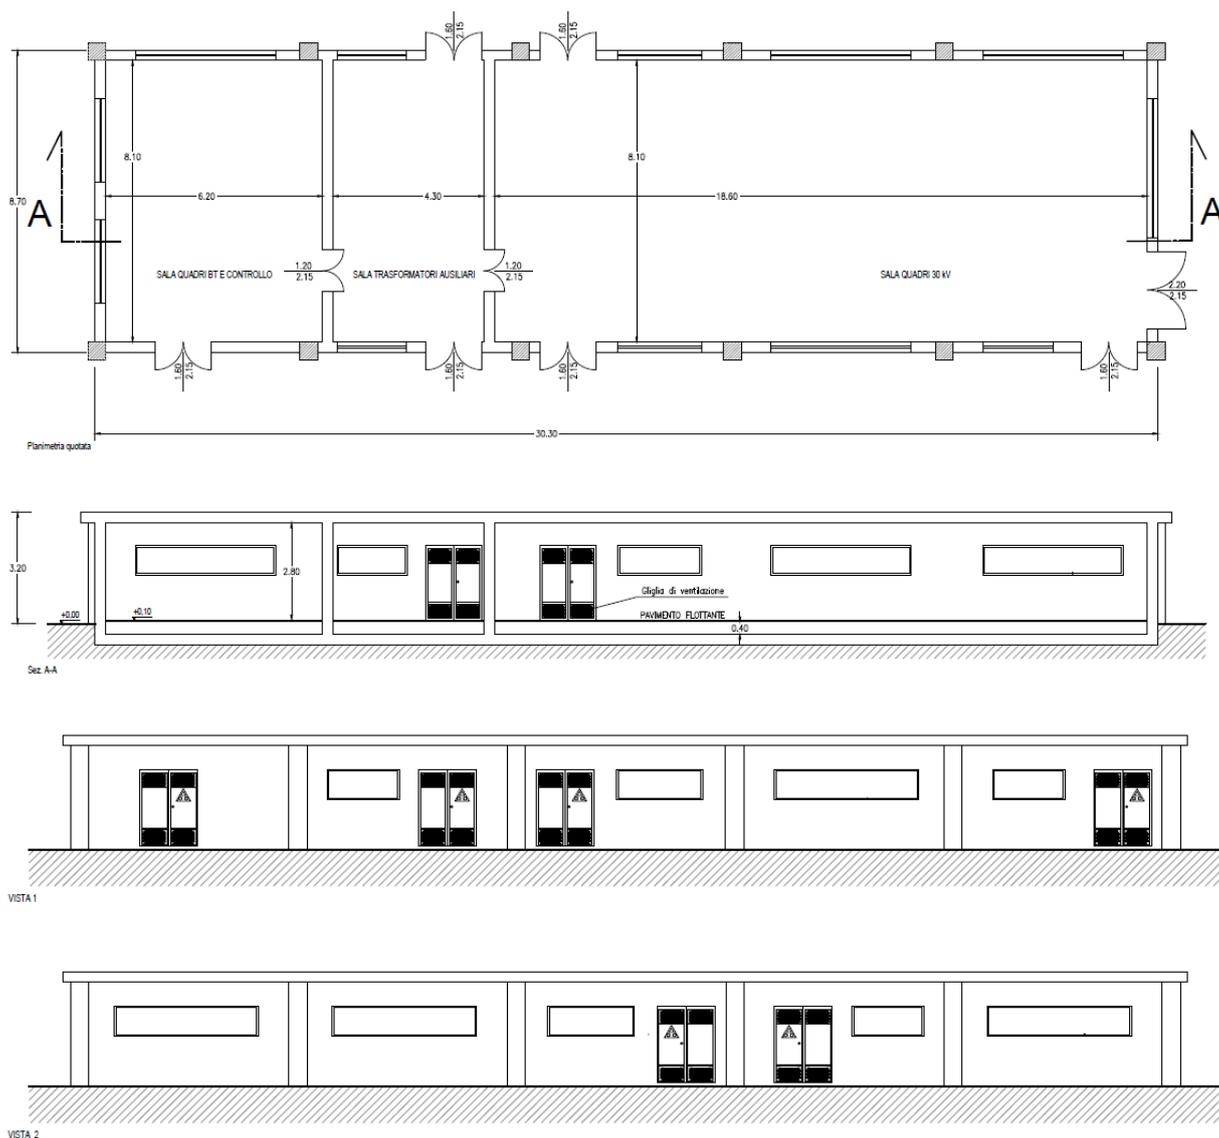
Viste in pianta e prospetto cabina generale BESS
